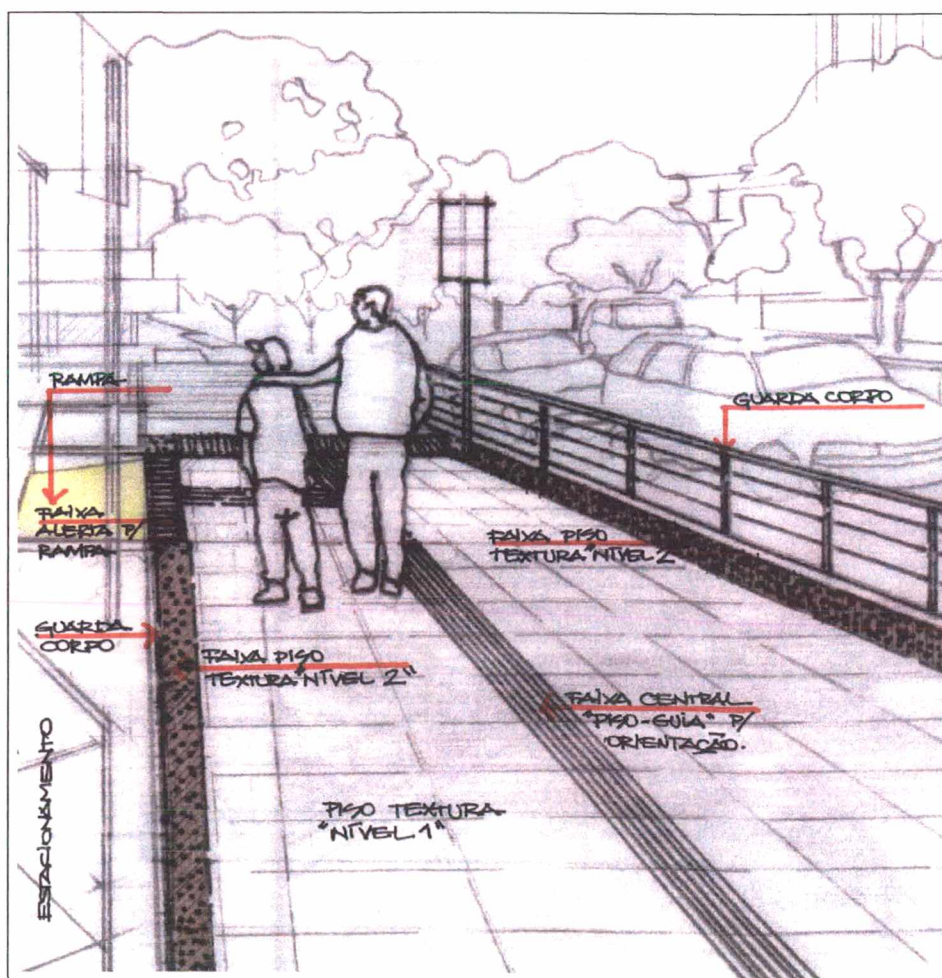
Vista do cruzamento: Travessa Júlio de Mesquita Filho e Travessa Guilherme de Almeida x Avenida Brasil x Praça Raposo Tavares.
